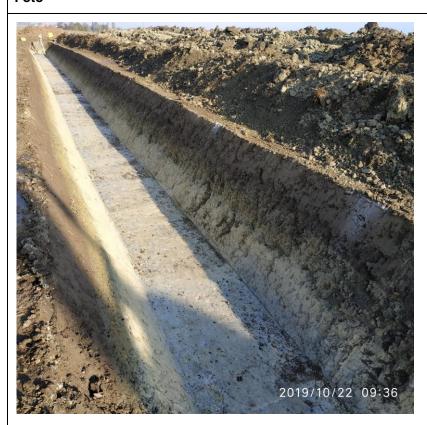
Scavo del canale perimetrale lungo il lato ovest dell'area di espansione.
